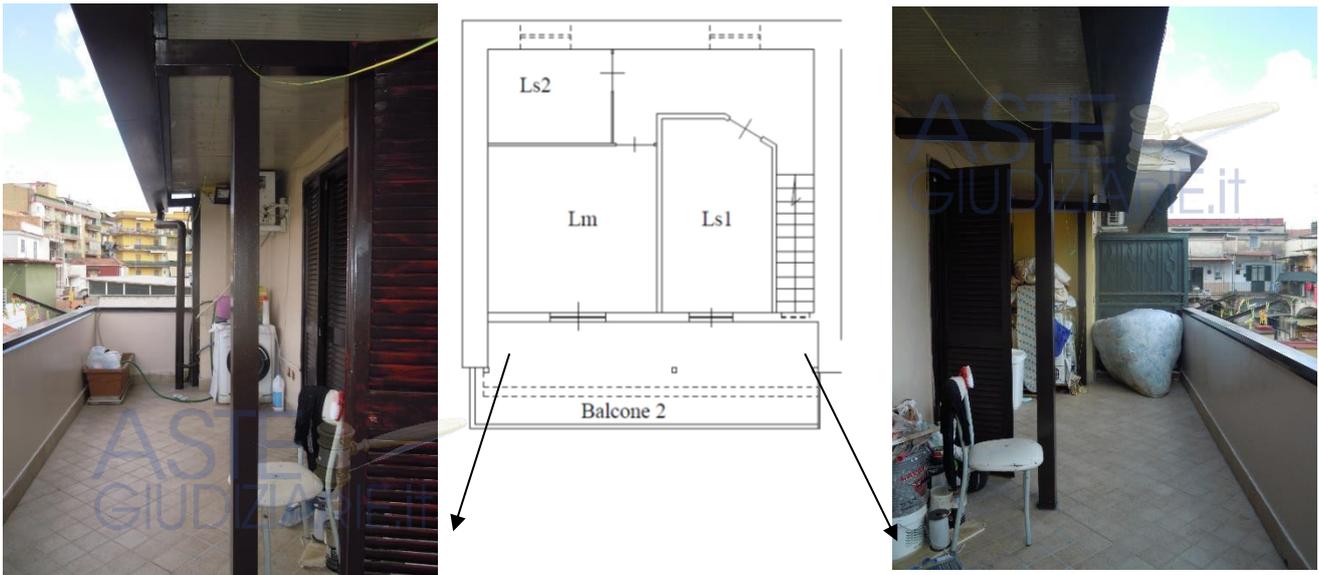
Individuazione fotografica degli esterni dei beni oggetto di pignoramento.
